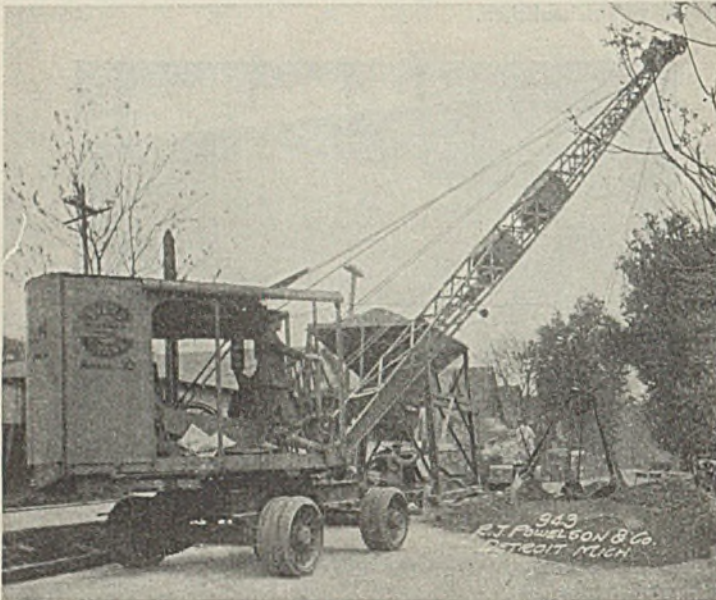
Autokran (Bauart Byers) mit Greifer bei Straßenbauarbeiten.
